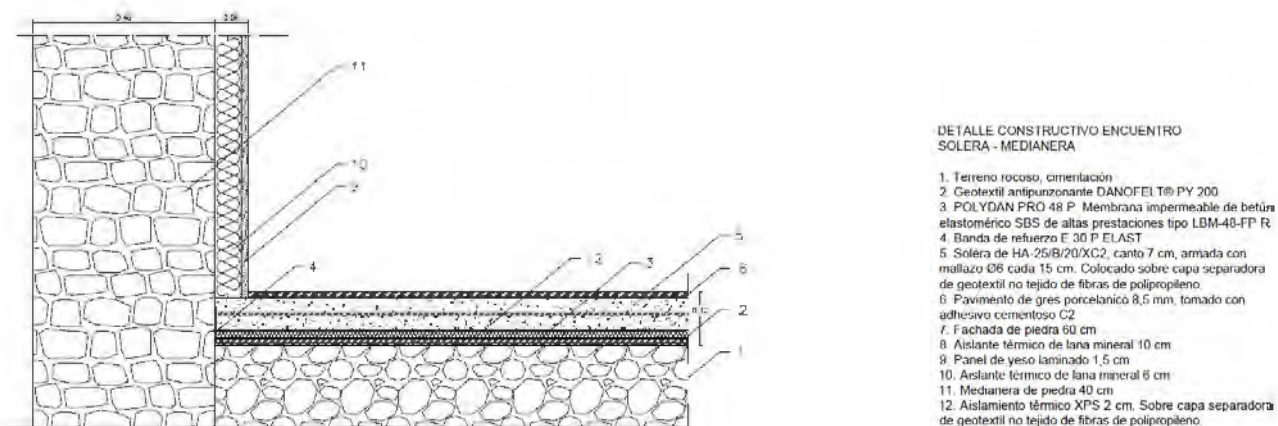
Detalle constructivo solera – medianera. Fuente: propia.
